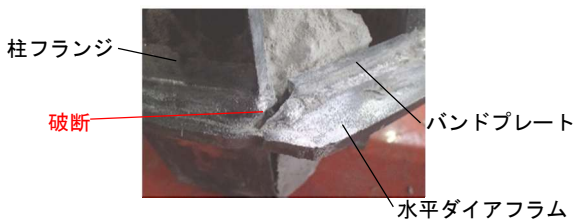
No.1 試験体の水平ダイアフラムと溶接部破断
